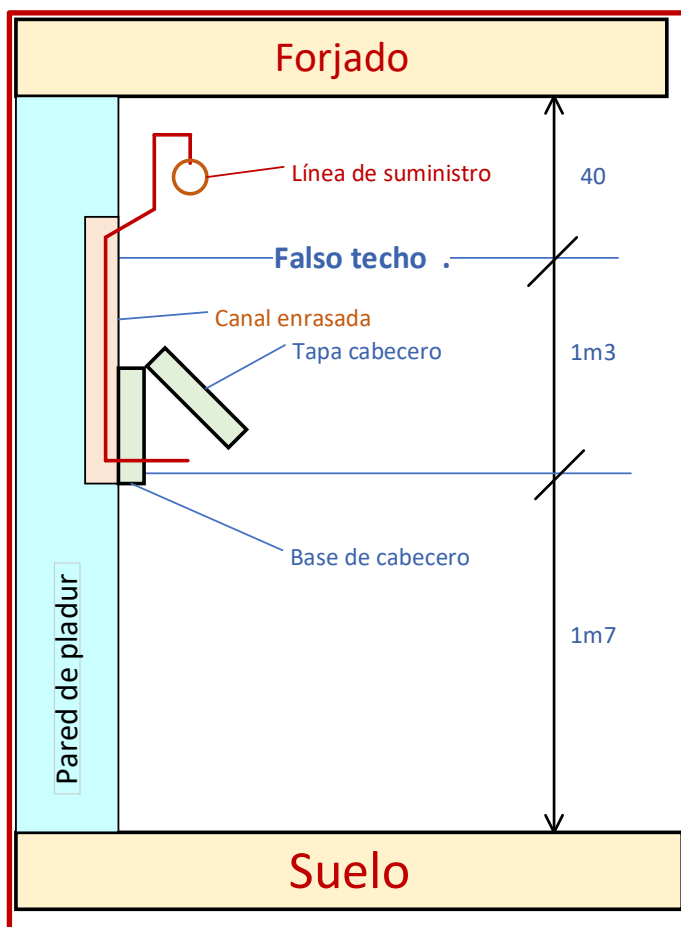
Sección con paredes de pladur y bajantes por canal enrasada
